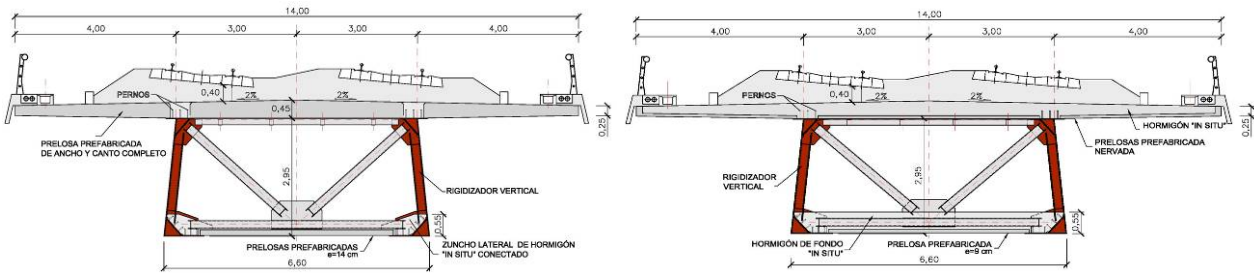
Sección por zona de centro de vano. Figura 3. Sección por zona de momentos negativos.
